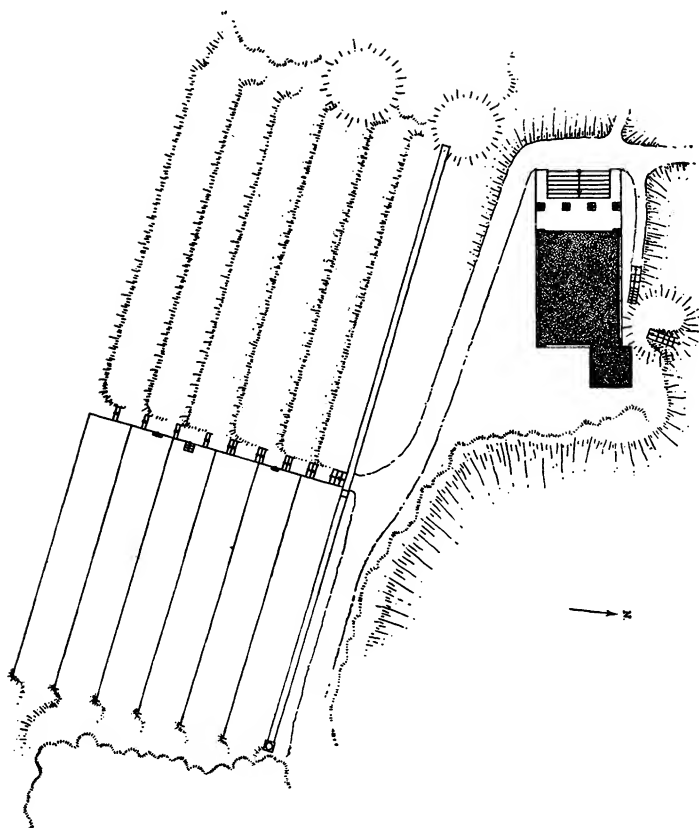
Dessau—Groß-Rühnau. Park. Lageplan des Weinbergschloßchens
